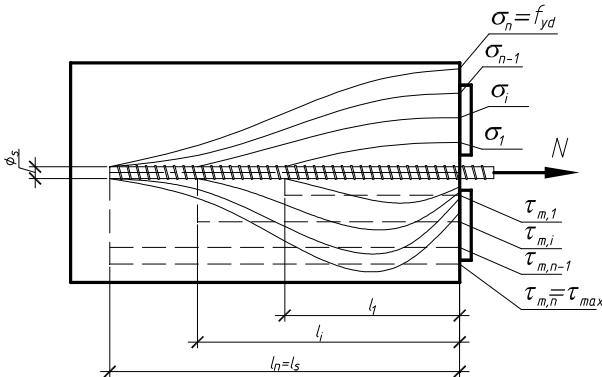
Напружено-деформовані стани арматури та бетону впродовж висмикування арматури з бетонної призми
